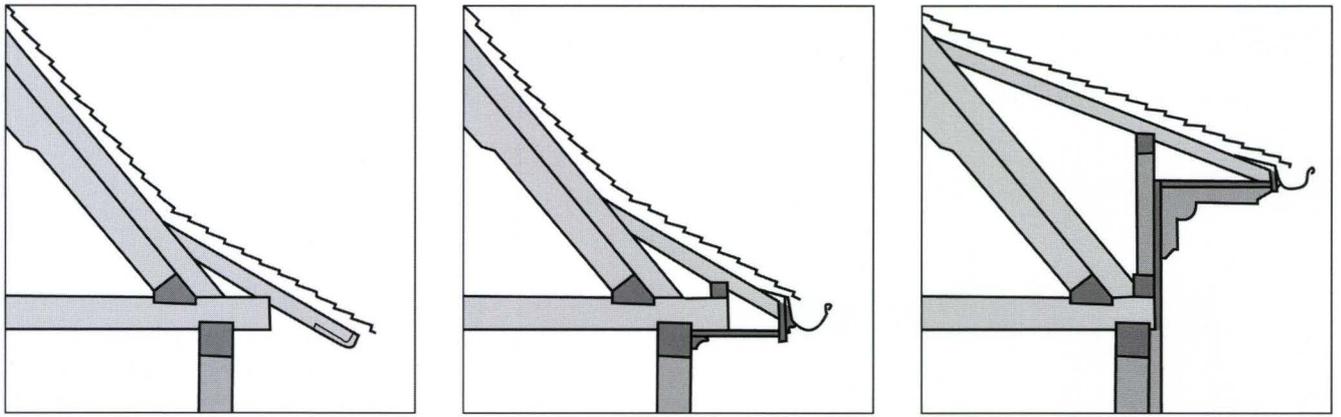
Leonhardsgraben 38, «im Rosgarten» (D 1998/29). Rekonstruktion der Traufausbildung. Der auf einem Fachwerkgeschoss abgezimmerte liegende Stuhl bildete ursprünglich einen unverkleideten Dachvorsprung mit vorkragenden Bundbalkenköpfen. Bei einer ersten Umgestaltung wurden die Balken abgelängt und die Untersicht verkleidet. Mit dem Höhersetzen der Traufe durch den Einbau eines Kniestocks wurde Platz geschaffen für ein Konsolgesims. – Zeichnung: Rebekka Brandenberger.
